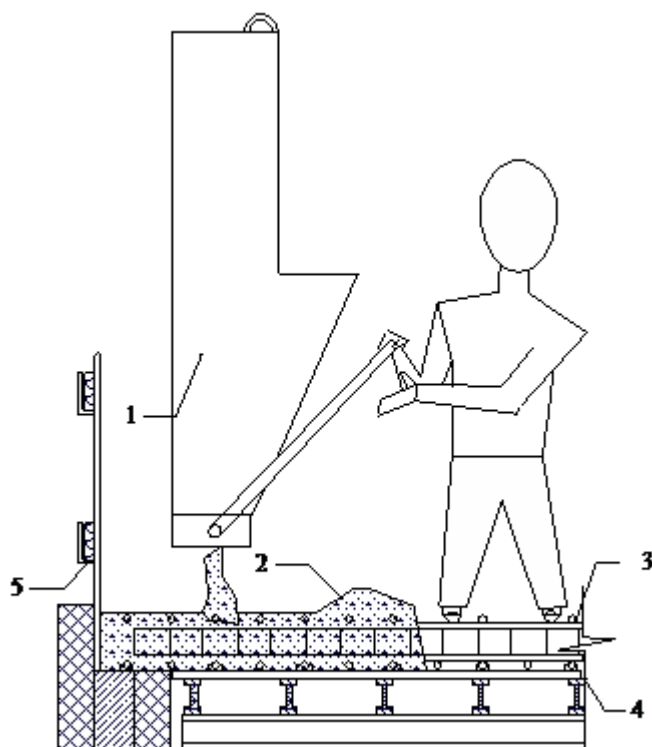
Укладка бетона: 1 – бункер для подачи бетона; 2 – укладываемый бетон; 3 арматурная сетка; 4 конструкция опалубки перекрытия; 5 инвентарное ограждение
